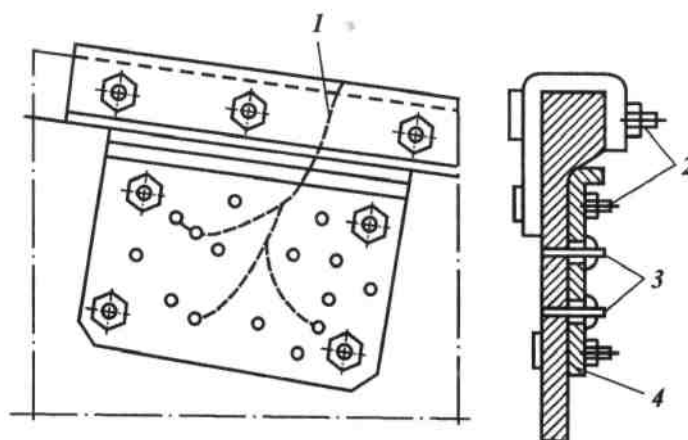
Установка накладки с болтами и ввертышами на месте трещины: 1 - трещина; 2 - болты; 3 - ввертыши; 4 - накладка
